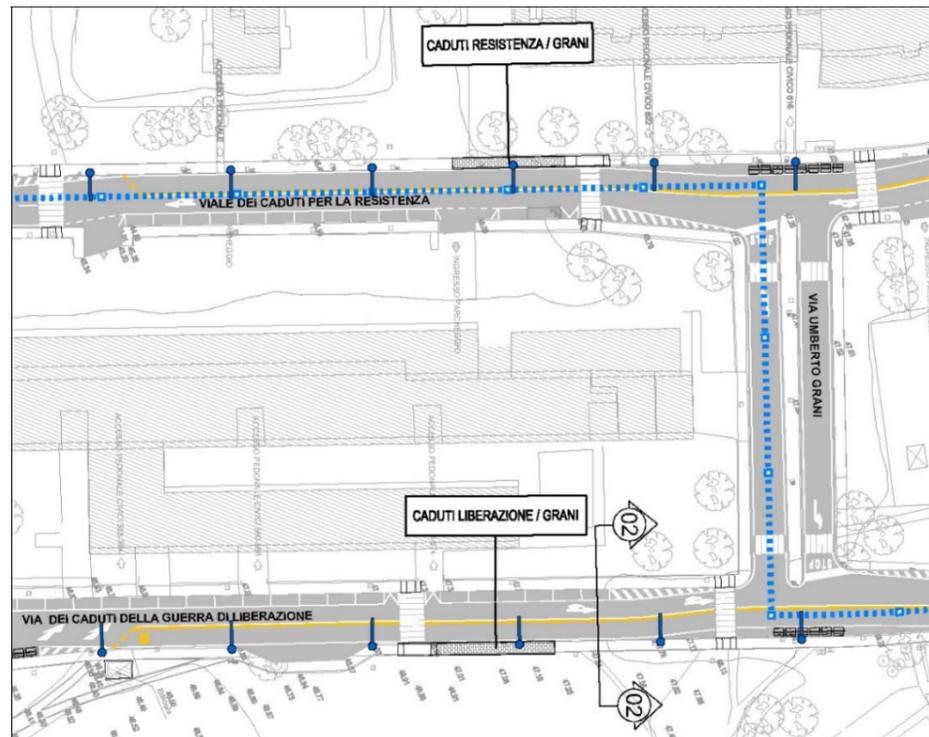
Stralcio planimetrico di progetto viale dei Caduti della Guerra di Liberazione
